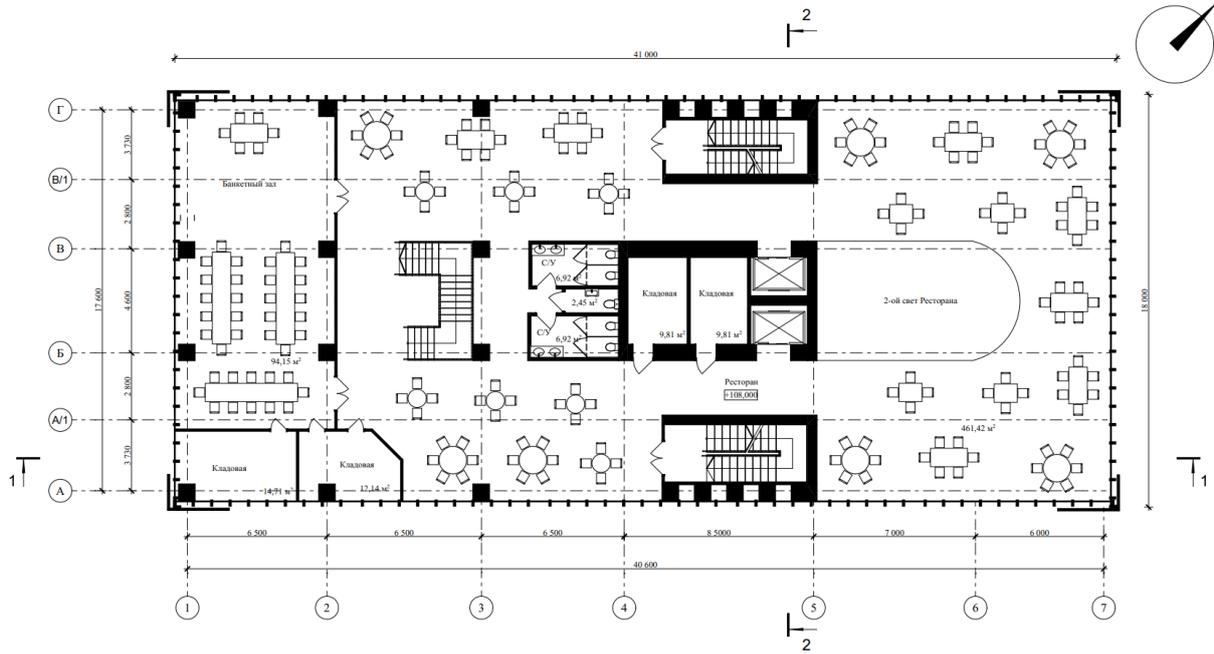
План 32 этажа (ресторан, 2-й уровень)
